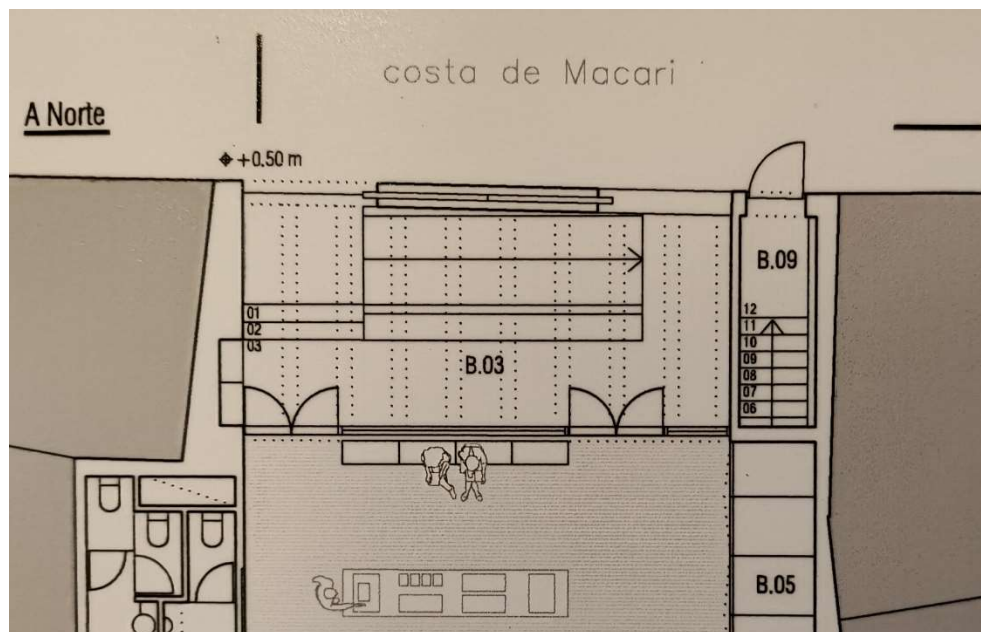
Detalle de zona de acceso a la planta baja por calle Costa de'n Macari nº 6 en PLANTA BAJA (escala 1:200) en la lámina 1/2 de la documentación presentada por el licitador
